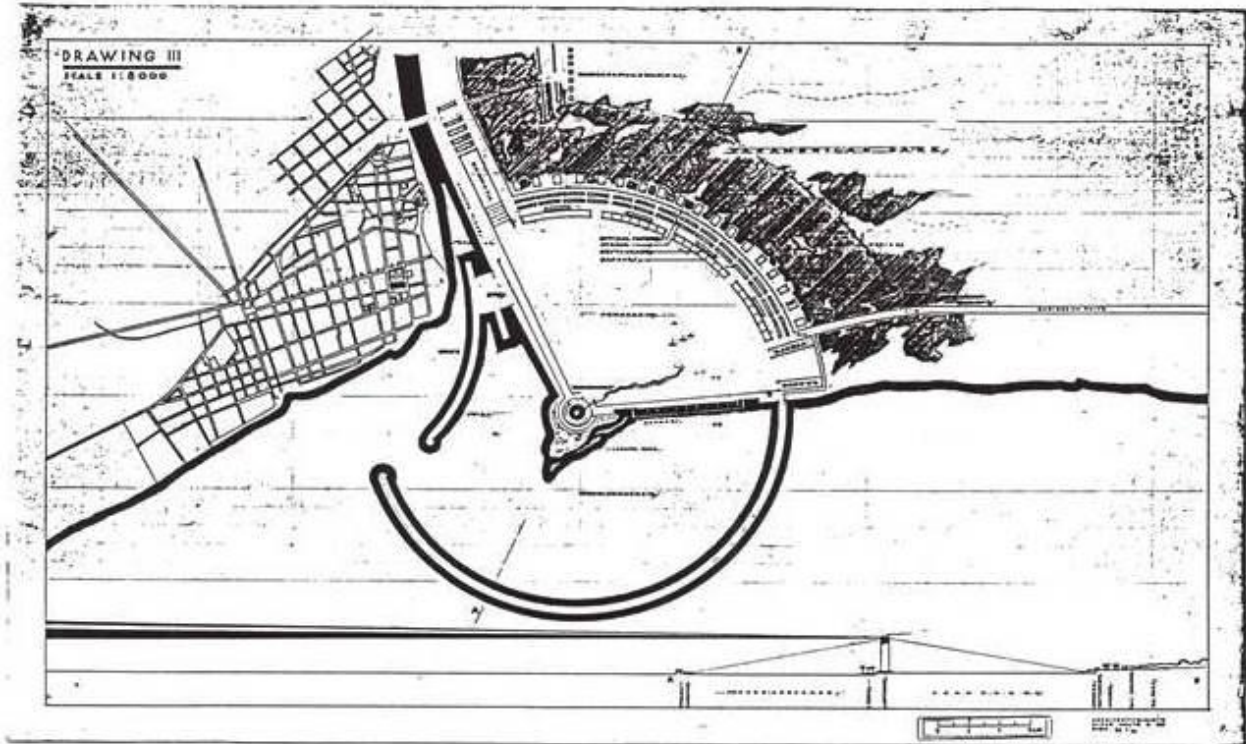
Planta y sección esquemática de la propuesta de Alvar Aalto para Faro de Colón en Santo Domingo (1929). Fuente: Archivo Garland.
